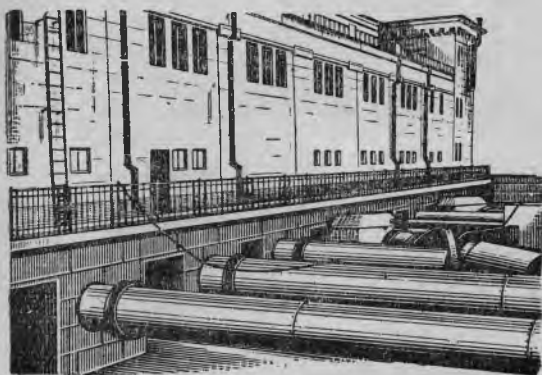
Выход напорных трубопроводов из здания станции (по рис. VII—24). Видны сальниковые компенсаторы и соединения труб с применением усиливающих ребер.
